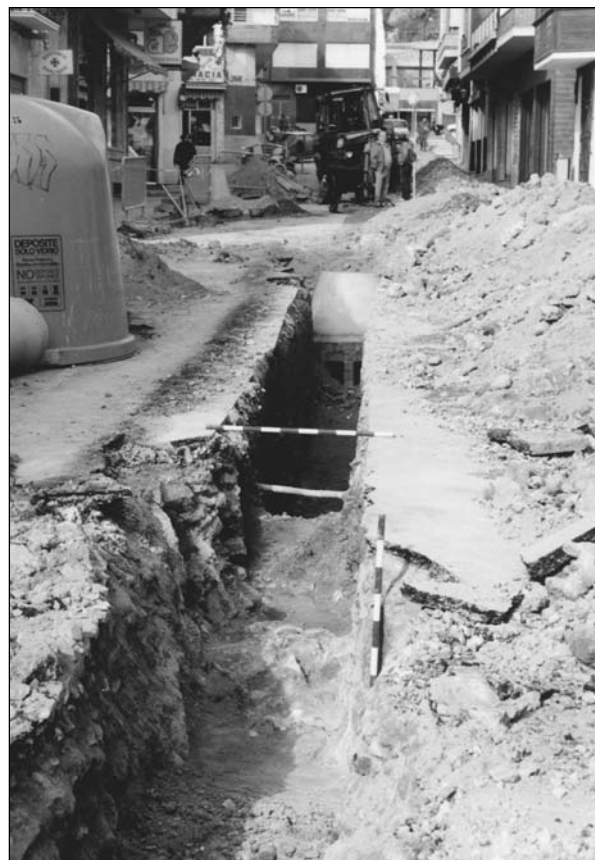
Vista general de la zanja con estructura 2 seccionada en primer término.
